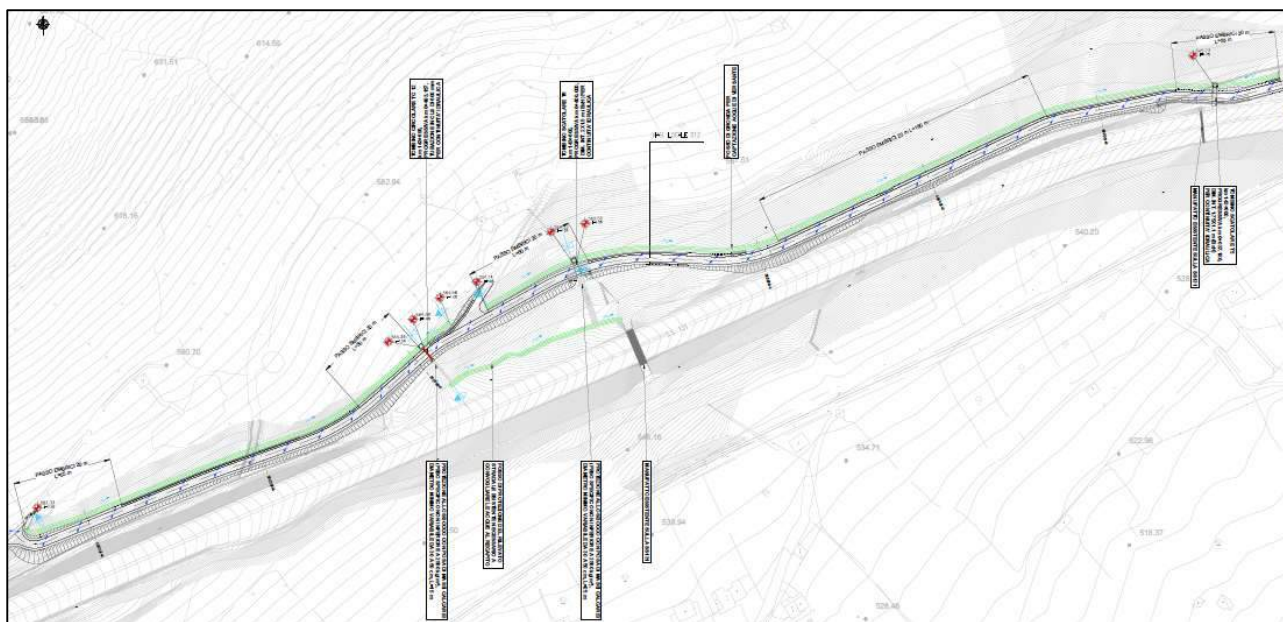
Stralcio planimetrico intervento S12-Risoluzione accesso C.N. dal km 143+215 al km 143+900
